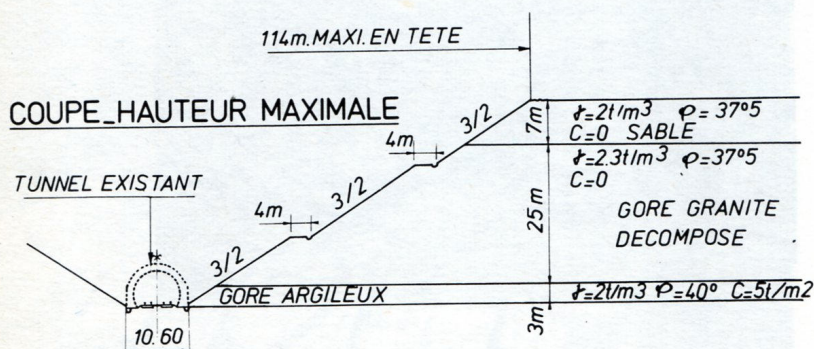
Tunnel du Crozet. Coupe de la tranchée.
